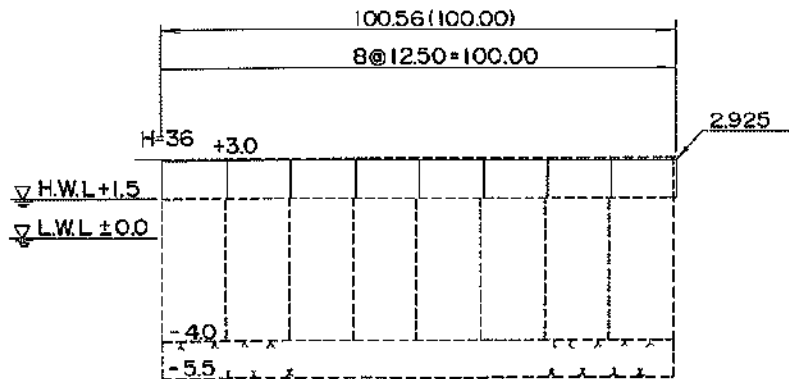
被災状況平面図・法線変位図 (第3埠頭地区, ①東側物揚場(-4.0m))
